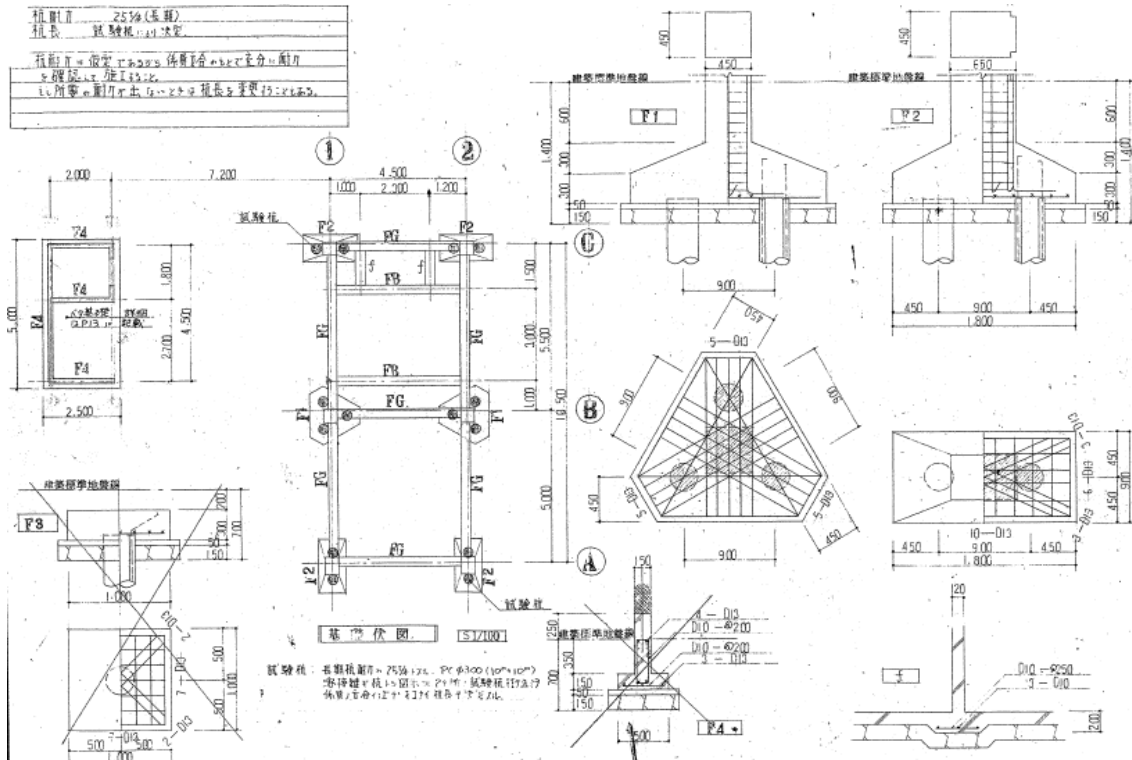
建築物 基礎伏図および杭詳細図
